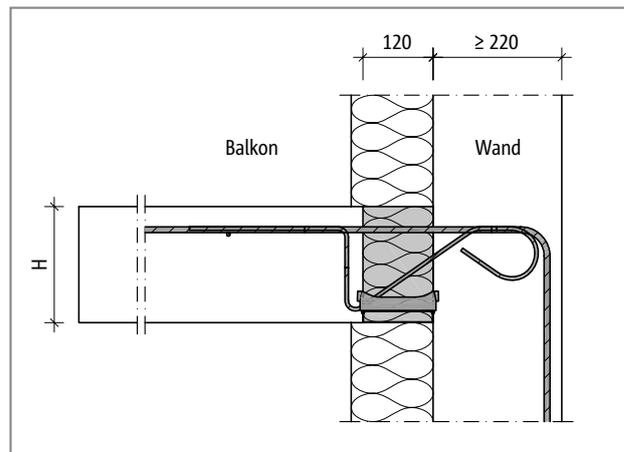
Schöck Isokorb® Typ KXT-WU: Wandanschluss nach unten bei Au-ßendämmung
